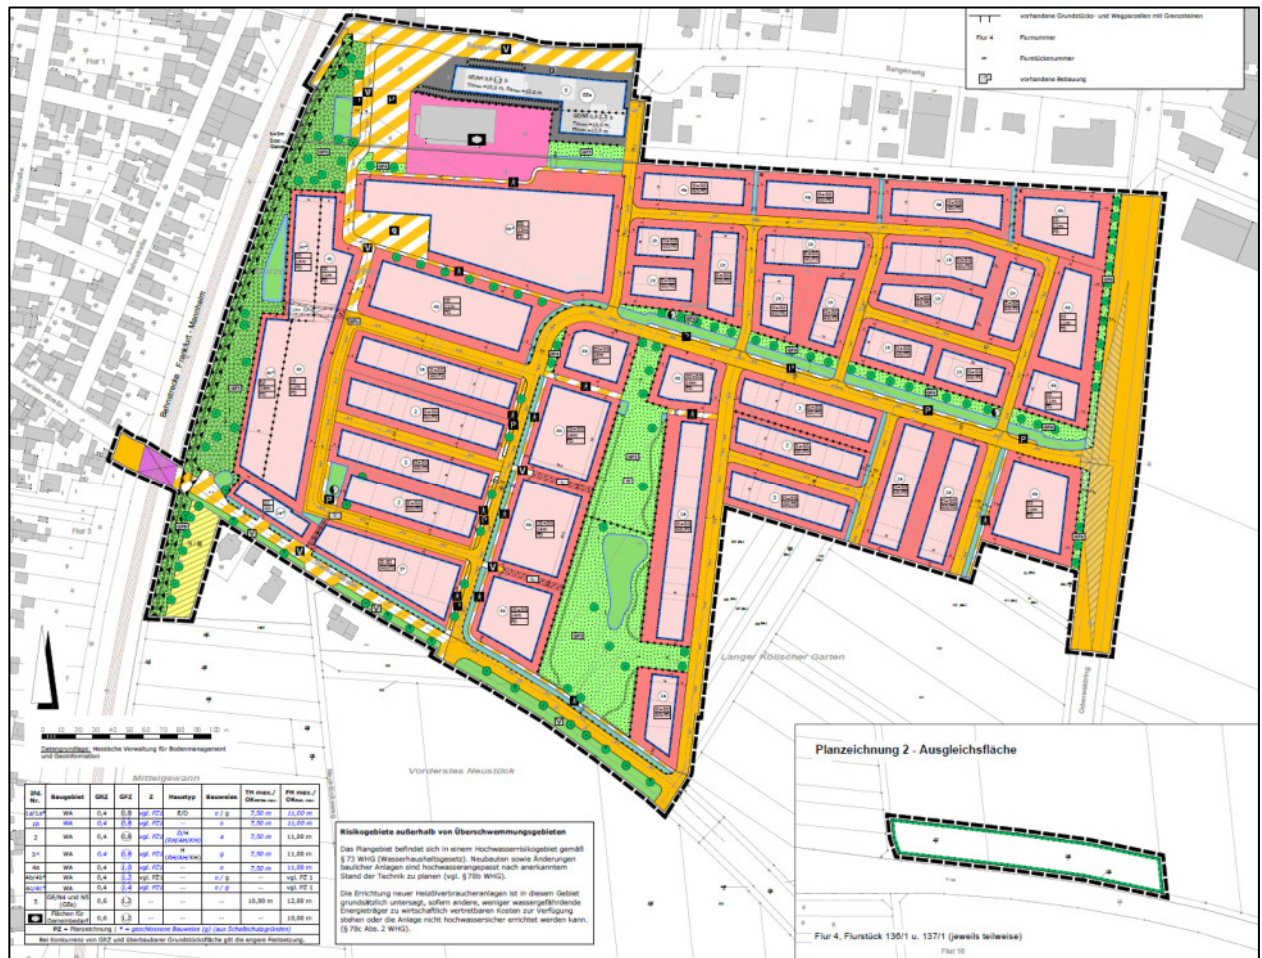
Ausschnitte aus dem 2. Entwurf zum Bebauungsplan „Köllsche Gärten - Wohnen am Kühkopf“ 1. Bauabschnitt (Plan|ES, Stand 01.04.2026).
